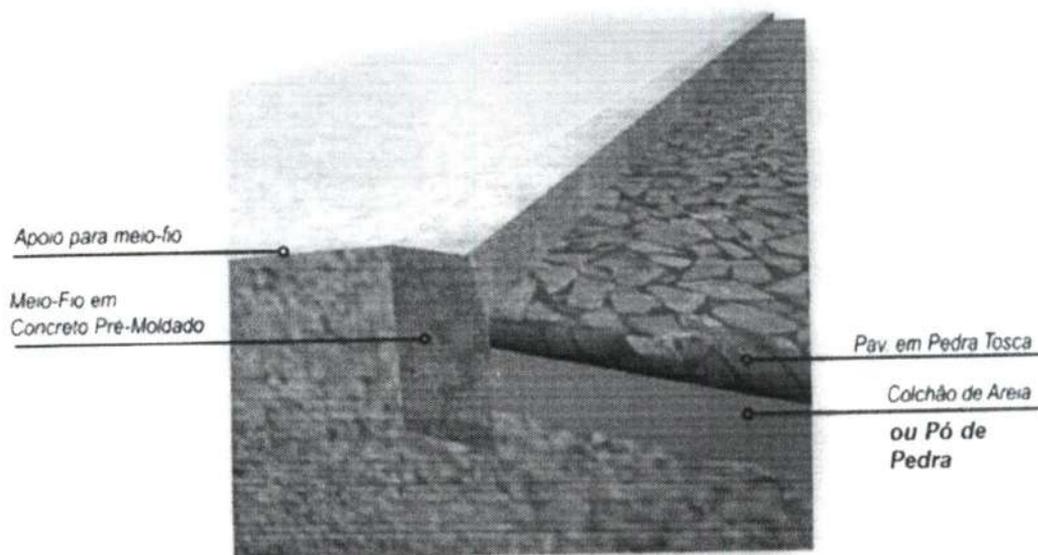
Detalhe construtivo de Pavimentação em Pedra Tosca
